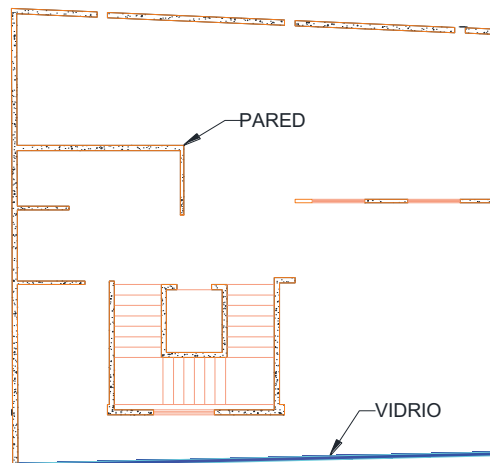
Ubicación de paredes y vidrios en la planta alta
